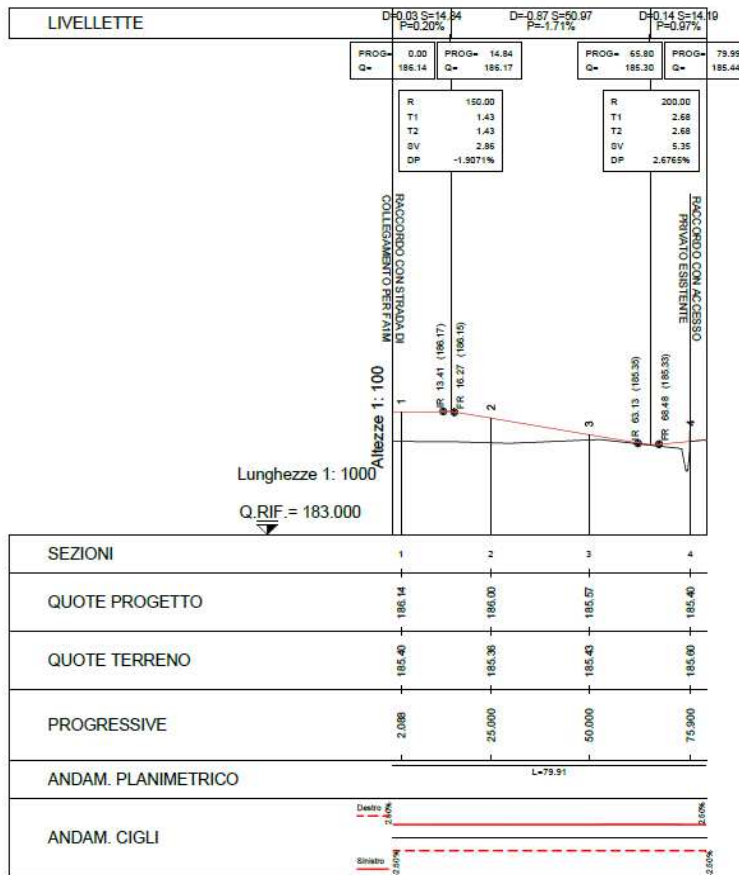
Profilo longitudinale dell'accesso alla 0+135
